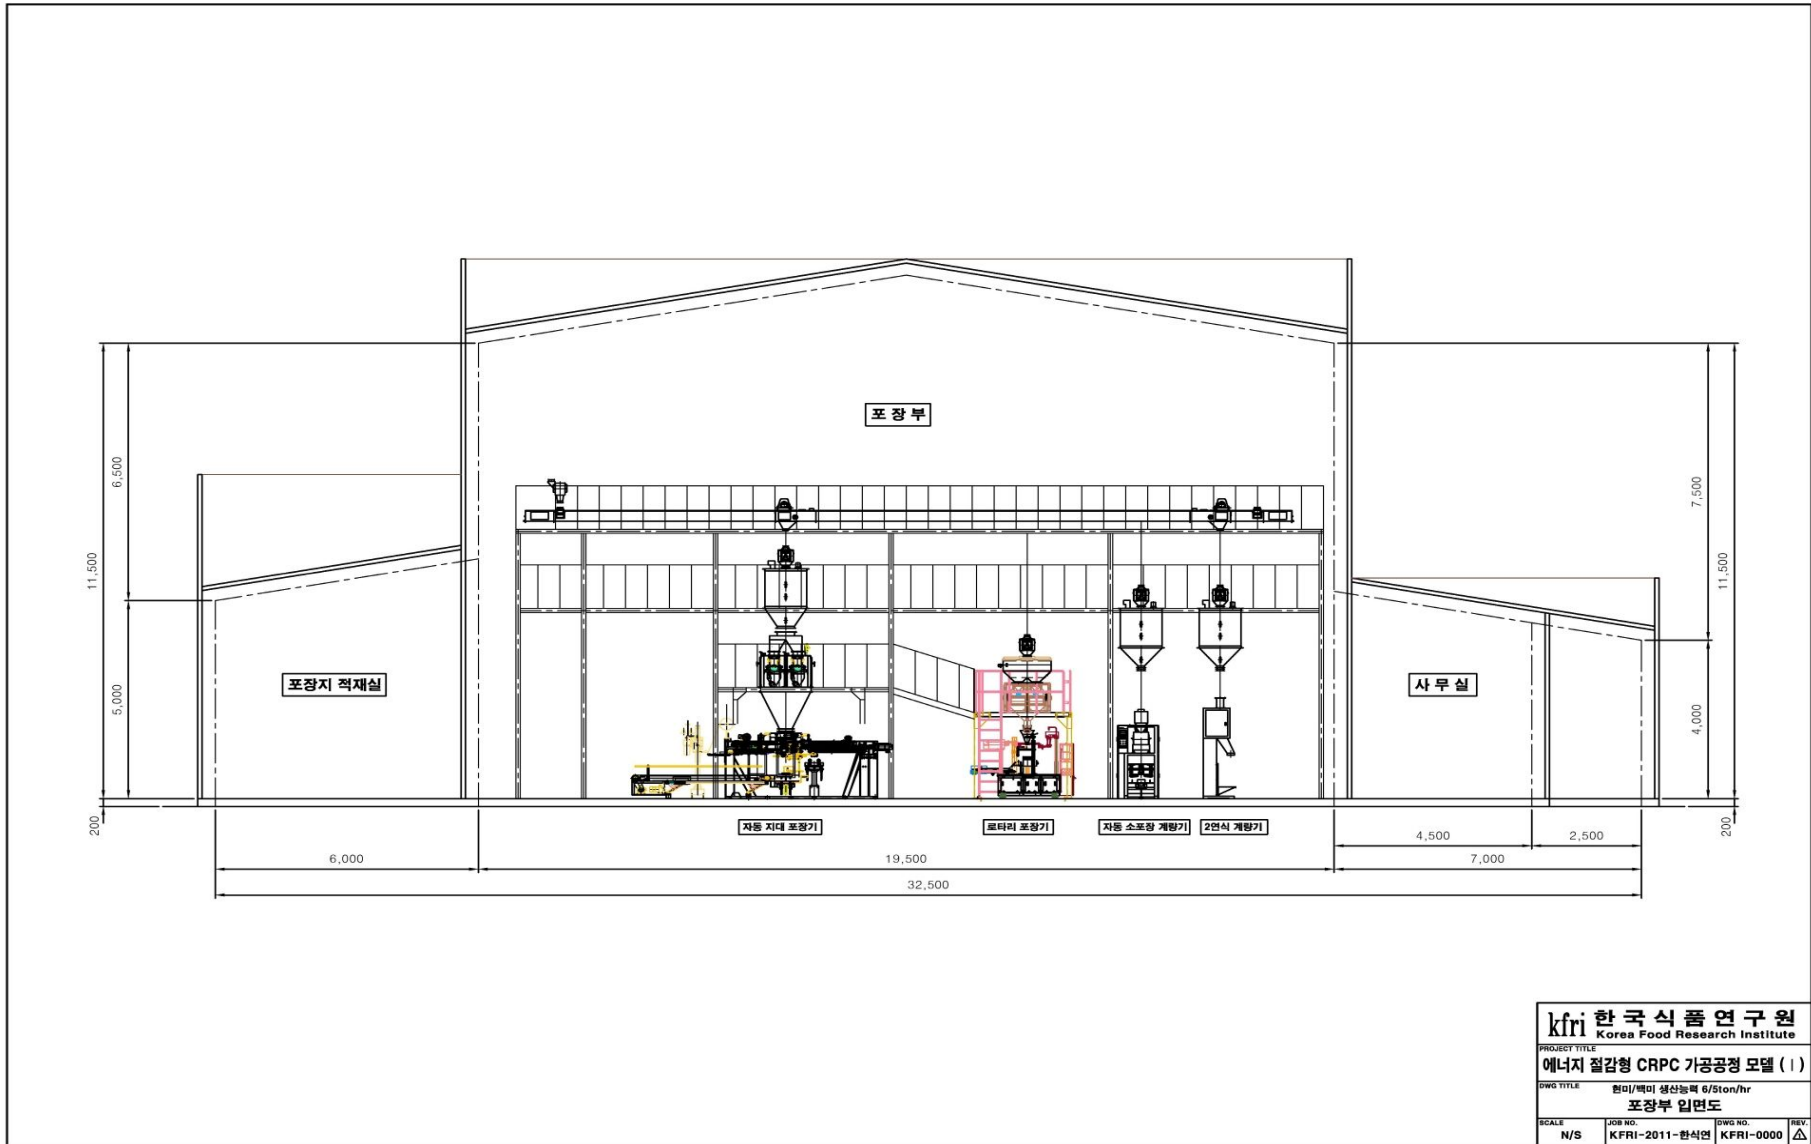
현미/백미생산능력 6/5ton/hr인 에너지절감형 가공공정 모델( I)의 포장부 입면도
